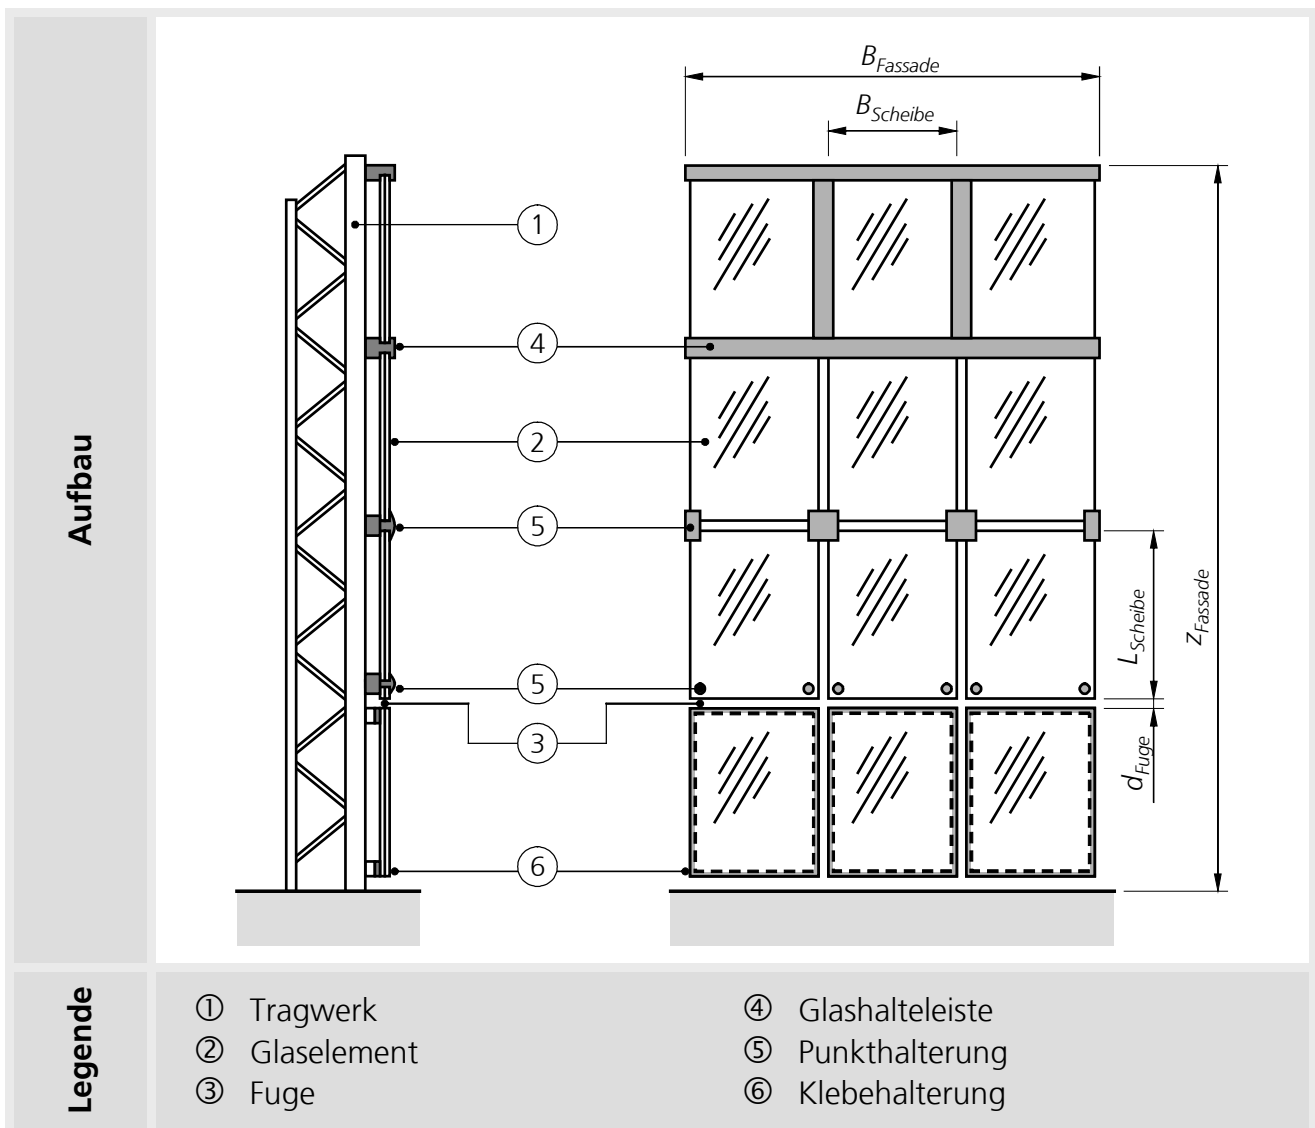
Grundaufbau einer Fassade mit Tragwerk, Glaselement und Glaselementbefestigung
